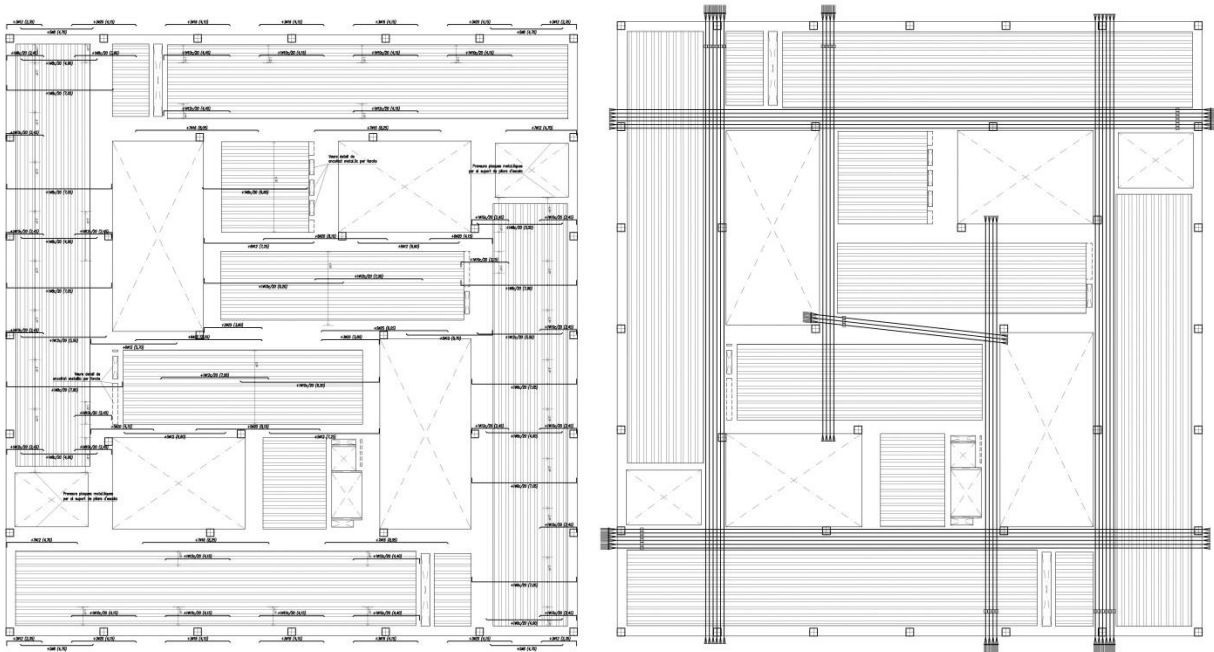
Plantas de estructura: armado longitudinal y jácenas postensadas
